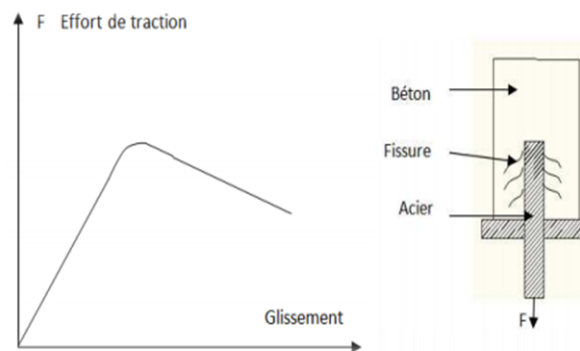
Comportement d'une barre d'acier soumise à un essai d'arrachement [14]
